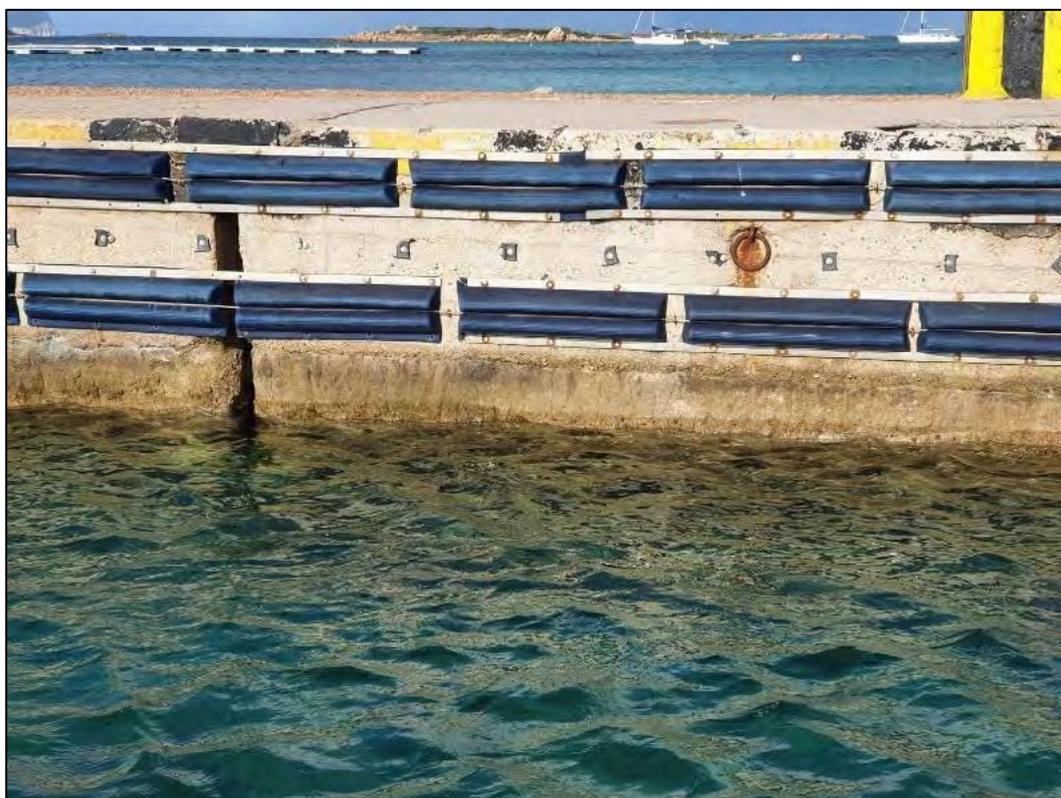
Foto dello stato attuale giunto tipo da ripristinare
